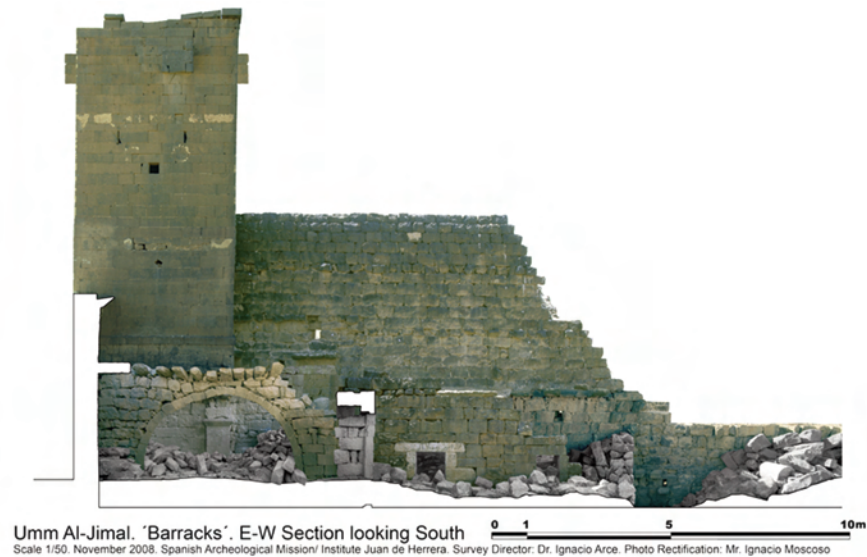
A Umm al Jimal. "Barracks" (Monasterio fortificado). Alzado ortorrectificado. Sección interior E-W mirando hacia el Sur.
